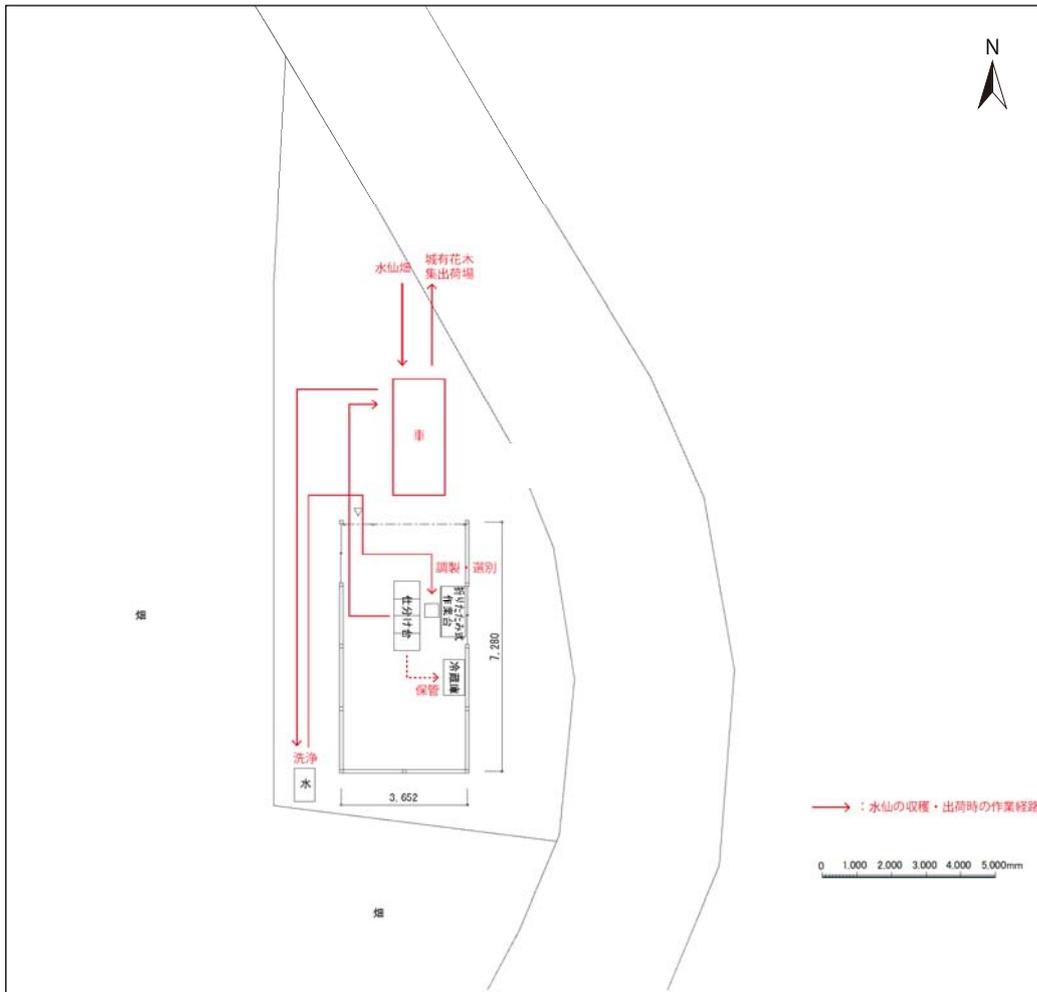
作業小屋（建築年不明）平面図 兼 作業経路図
